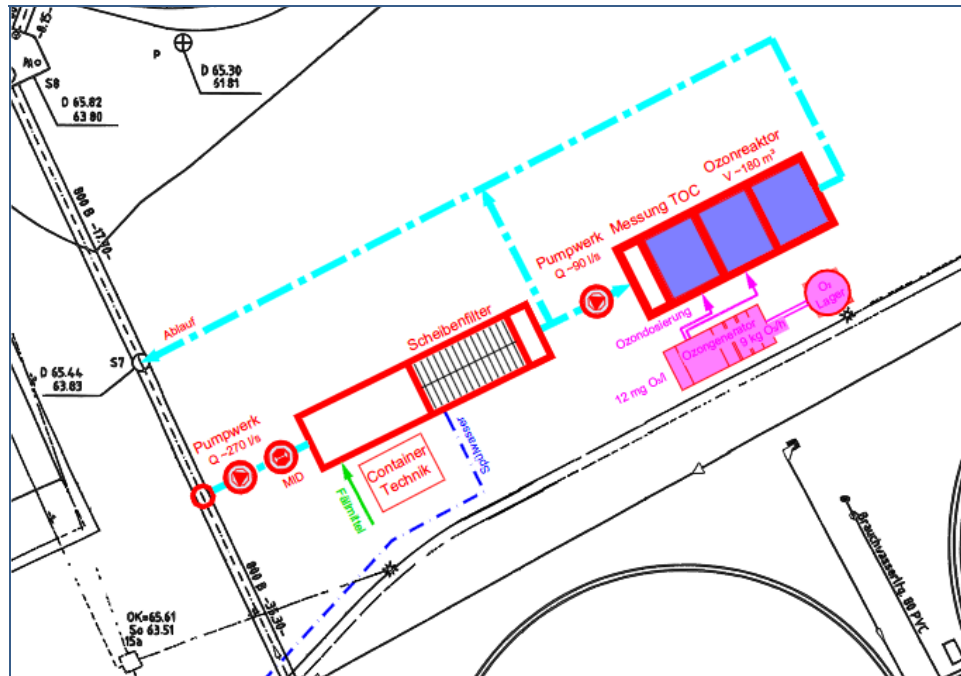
Lageplan KA Versmold - Variante 3.1 – Ozonung mit vorgeschaltetem Scheibentuchfilter und Schönungsteich
